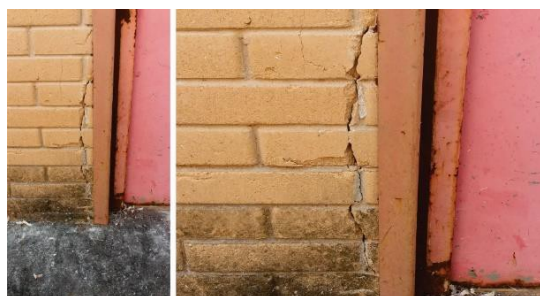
Fissura no bloco de solo-cimento – Prédio Principal Fonte: Autor
